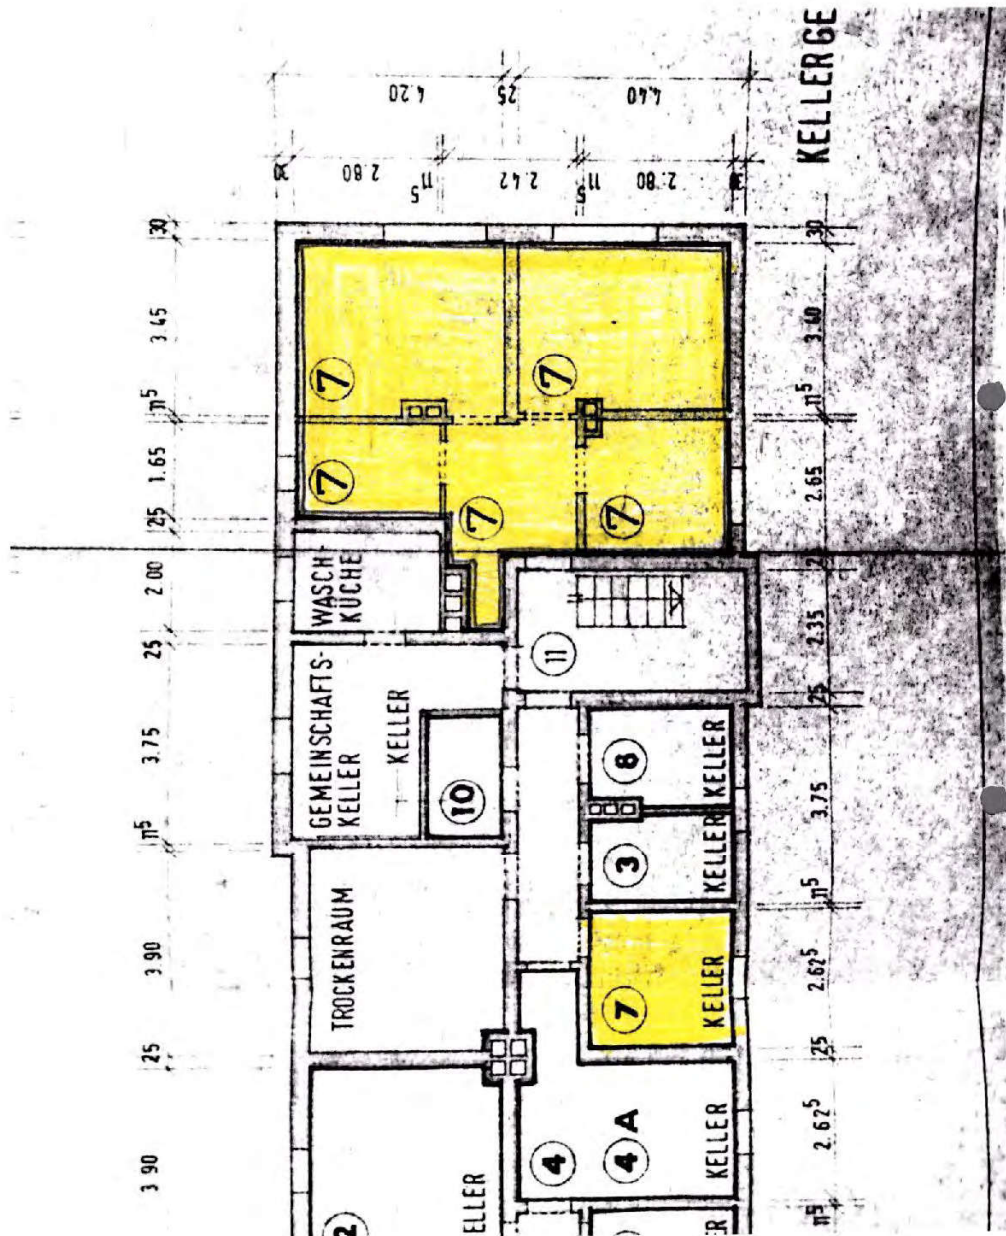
Teilgrundriss KG mit Kennzeichnung zugehöriger Kellerräume
